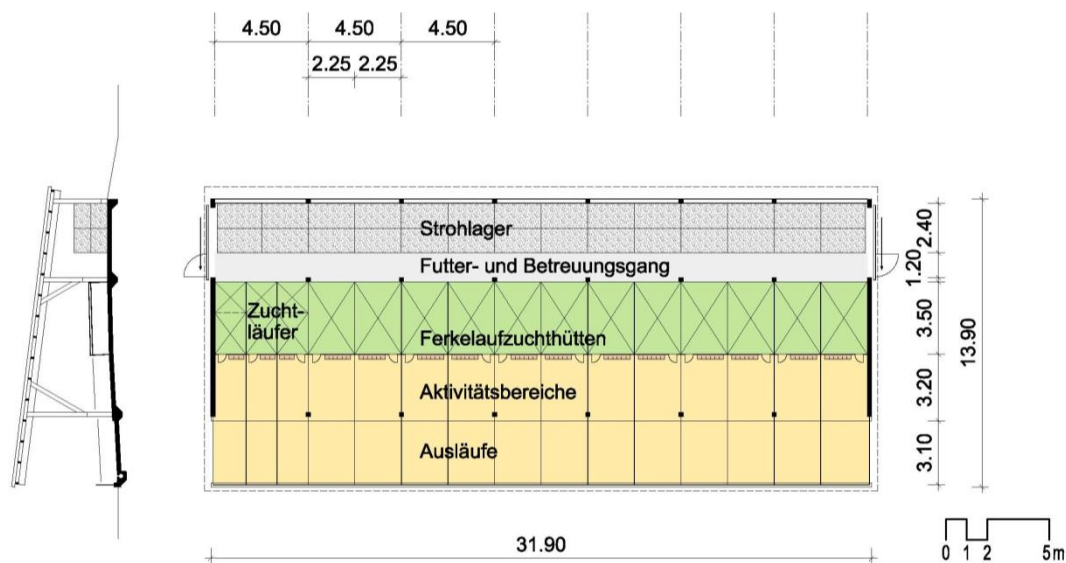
Grundriss und Schnitt des Ferkelaufzucht-Stallabteils
